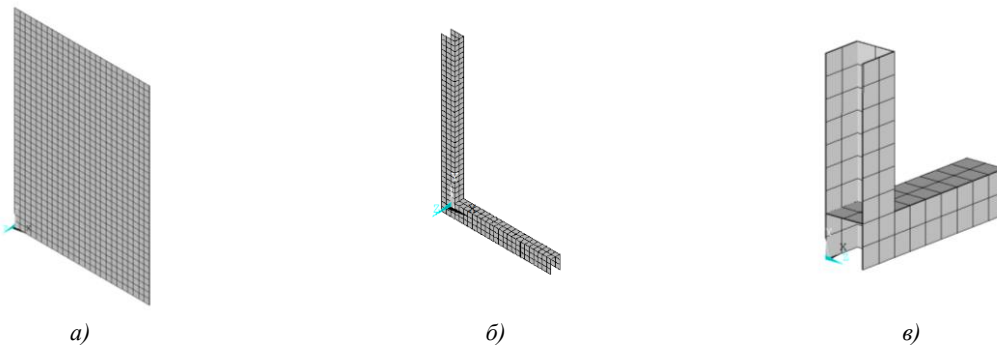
Эквивалентные армирующие слои: а — слой для фоновое армирования (верхнего/нижнего); б — слои армирования ригелей; в — слои армирования капители (рисунок авторов)
